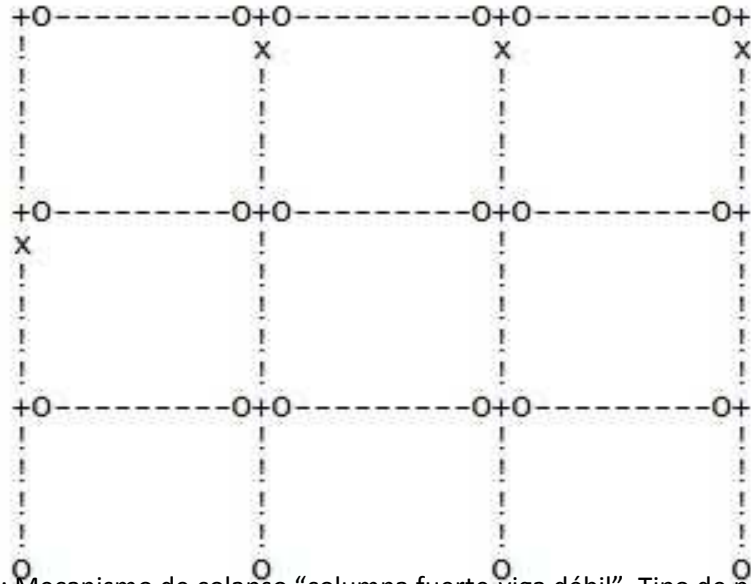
Mecanismo de colapso "columna fuerte-viga débil". Tipo de pórtico 2
